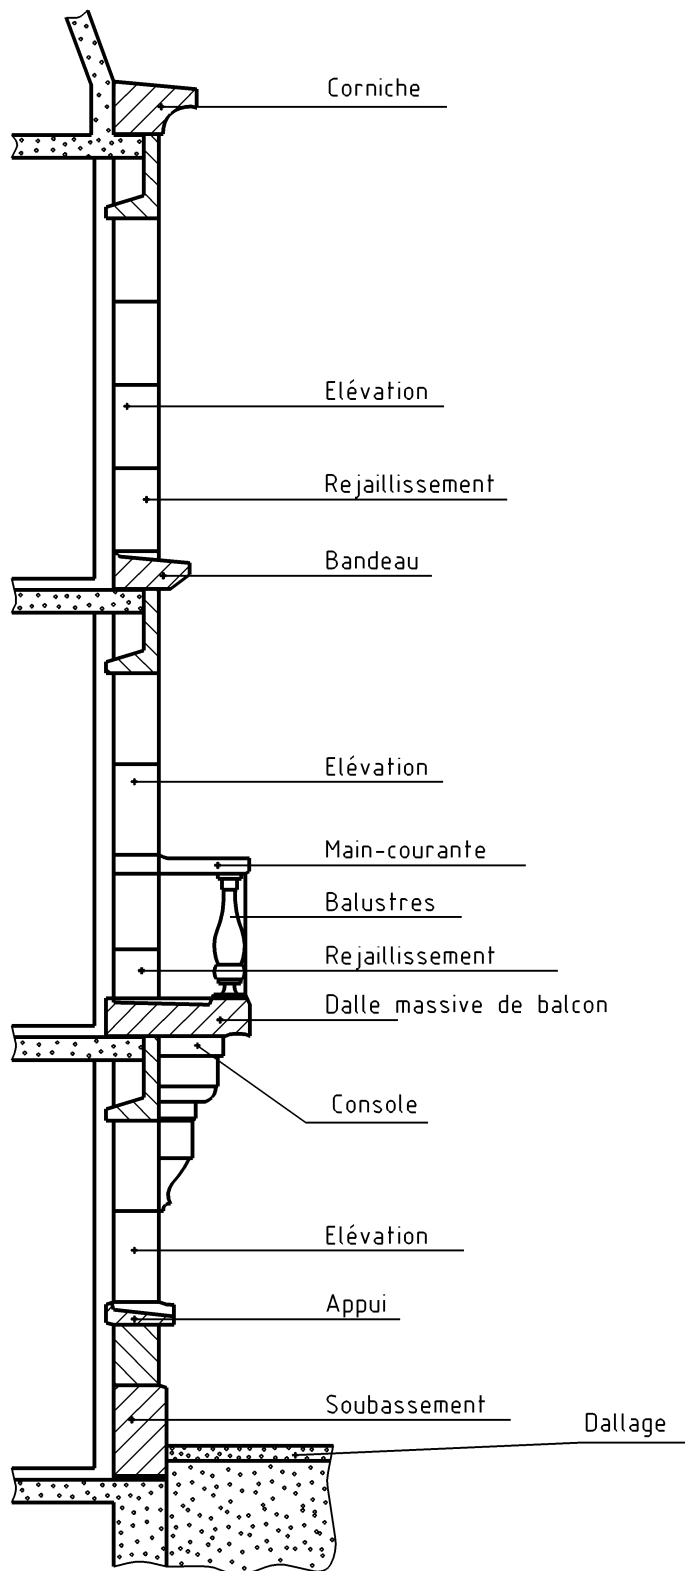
Façade en pierre naturelle massive (vue de coupe)
